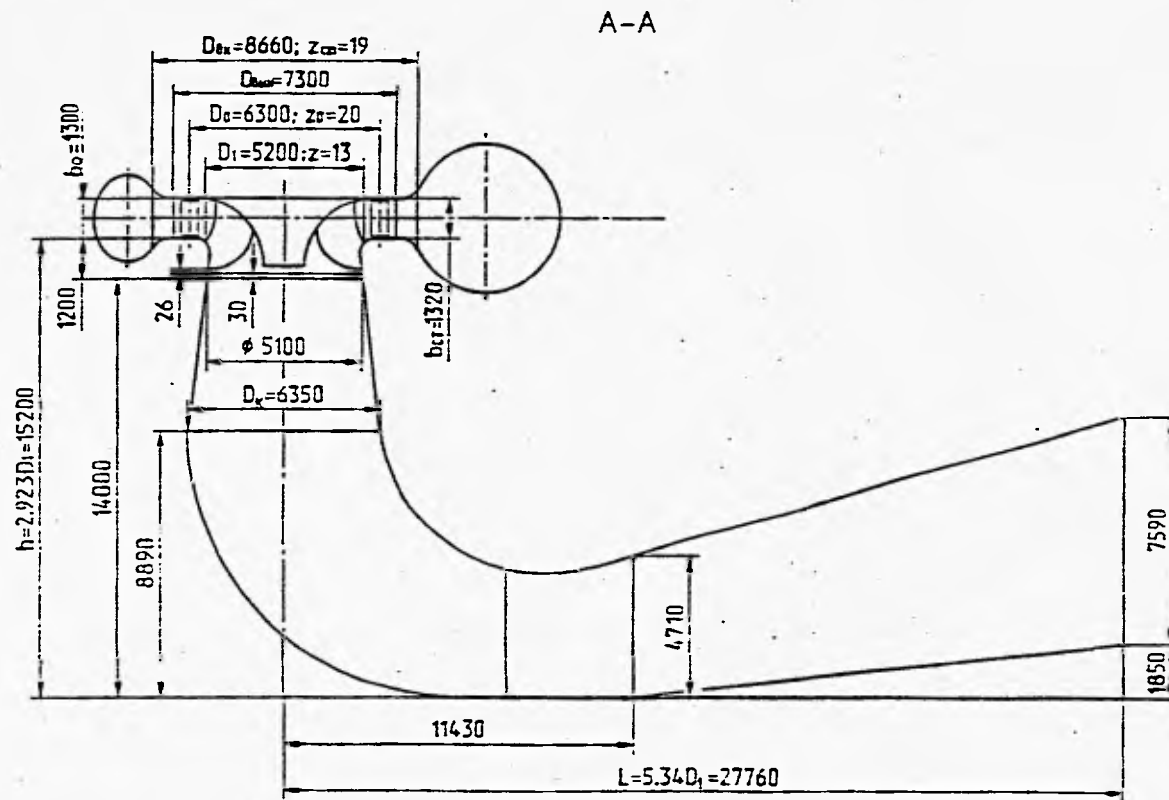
A VISTA EN PLANTA DEL PASAJE HIDRÁULICO DE LA TURBINA.
